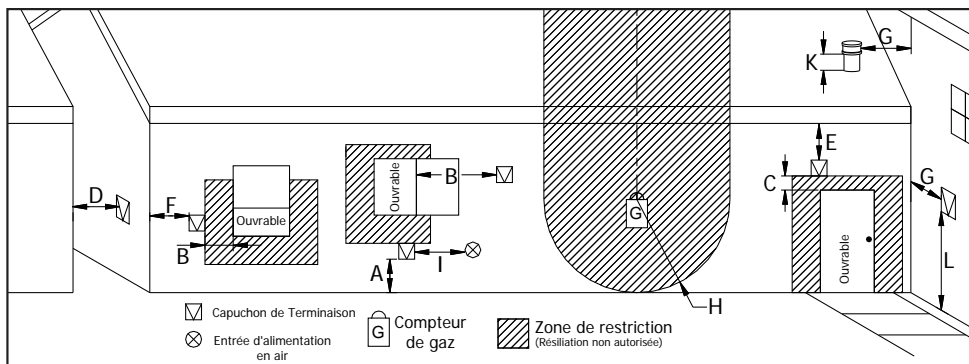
À utiliser conjointement avec le tableau 2 pour les emplacements de terminaison de ventilation extérieure admissibles.
